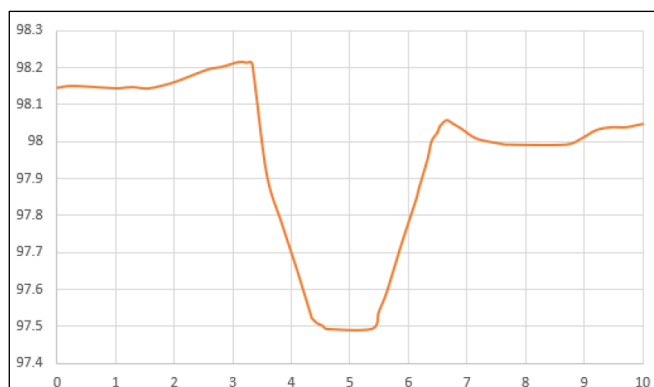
Secció transversal A-A' corresponent a la proposta de reperfilat de la secció de la cuneta de drenatge
